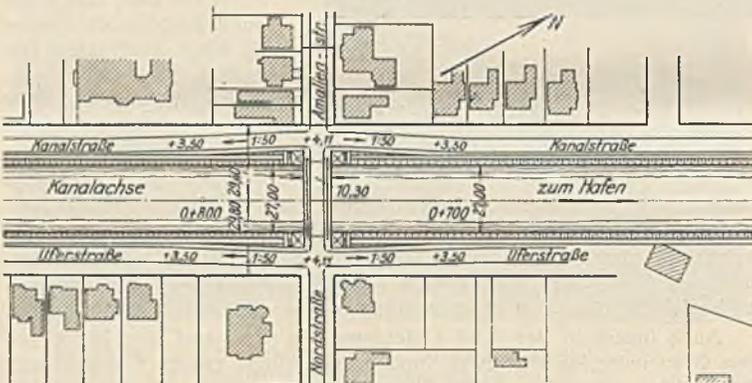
Lageplan der Brücke. Maßstab 1 : 3000.
